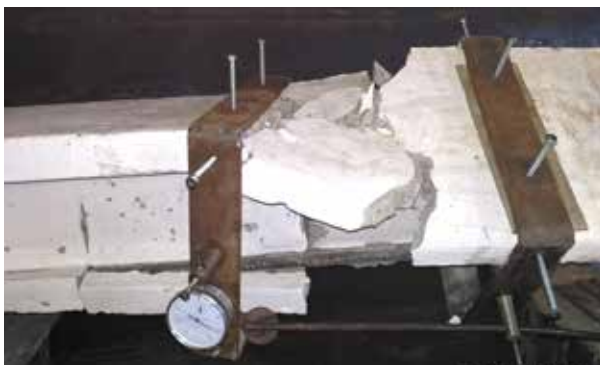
Передчасне руйнування балки від виколування поздовжньої арматури
